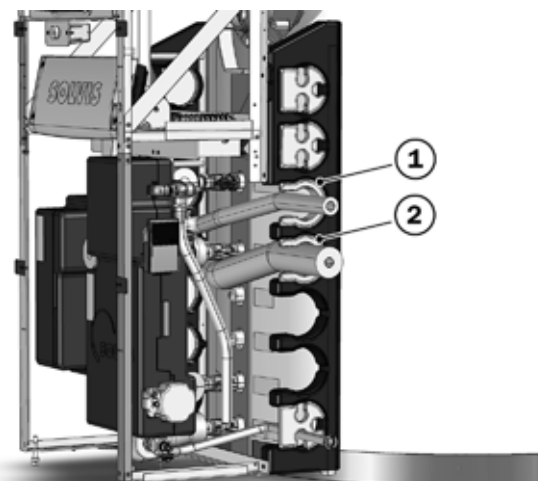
Warmwasserstation, Durchführung Trinkwasserrohre (rechts)
